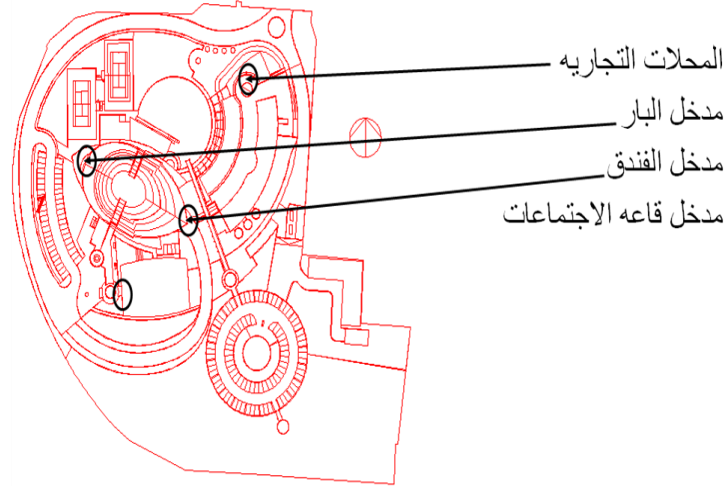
مسقط افقي عام يوضح مواقف السيارات
